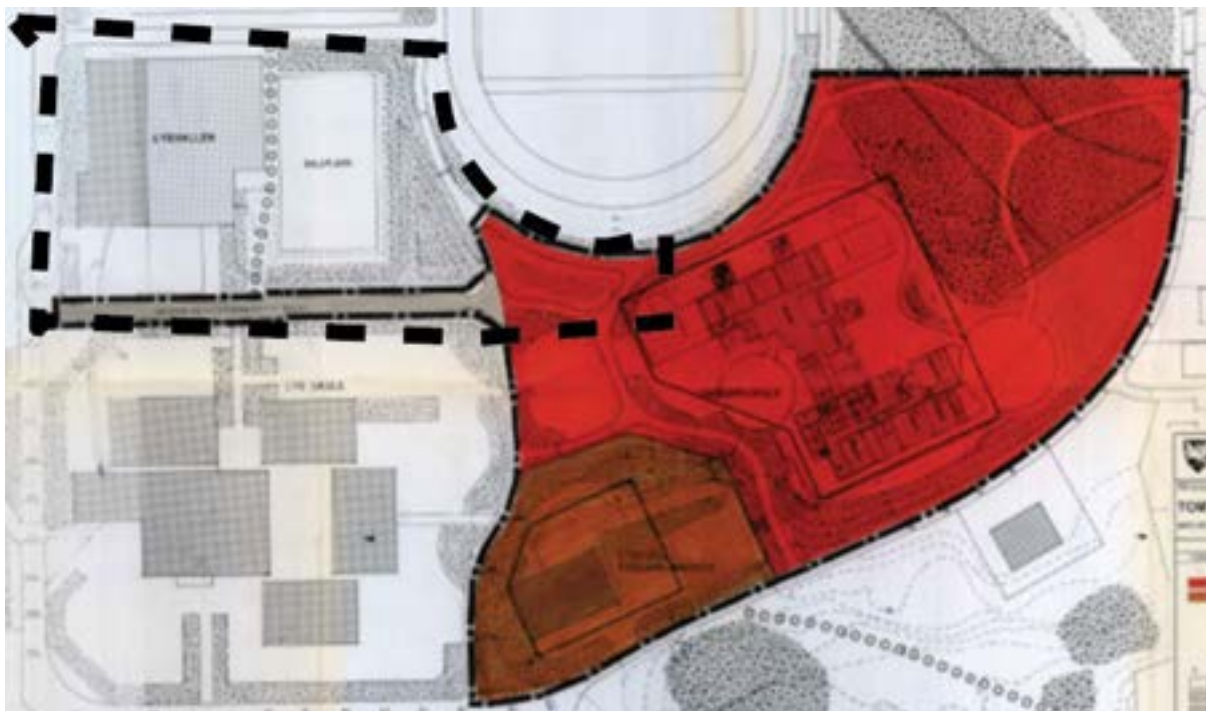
PLAN 0108 Grøntplan/busetnadsplan for Lye sentrum, planområdet markert med hvit stiplelinje.
